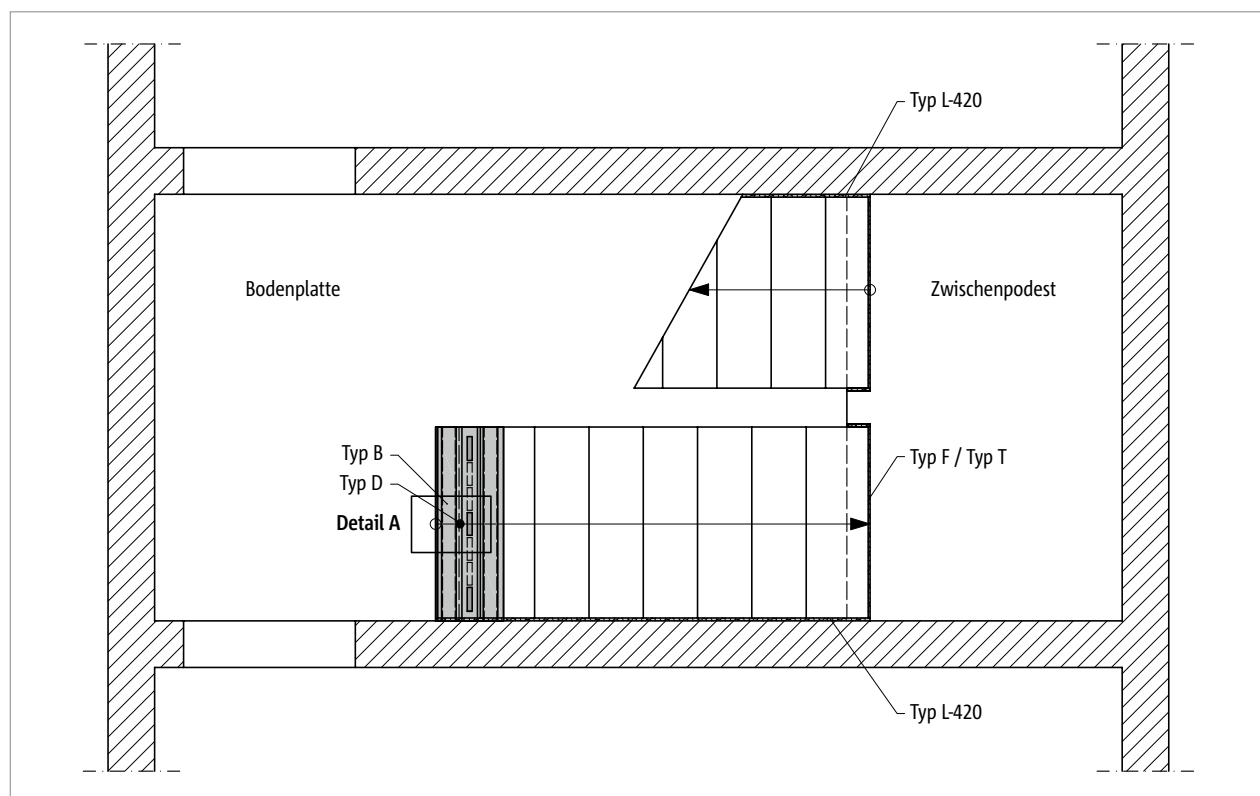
Tronsole® B + D: Elementanordnung im Grundriss
